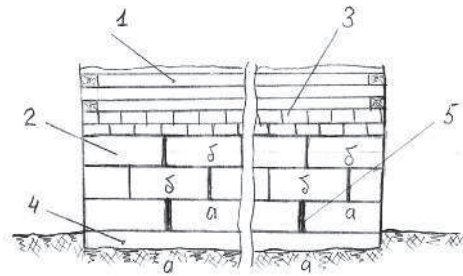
Схема расположения фундаментных блоков без заглабления: 1 – сруб; 2 – блоки фундаментные; 3 – цоколь из кирпича; 4 – песчаная подушка; 5 – щели между торцами шитов
